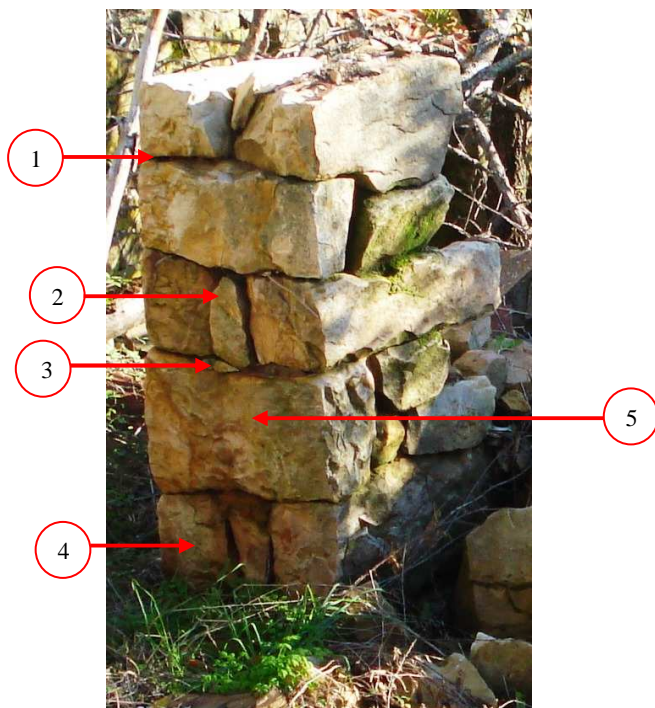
Détail constructif du chaînage d'angle (Source : manuel de réhabilitation du village Ait El kaid)
